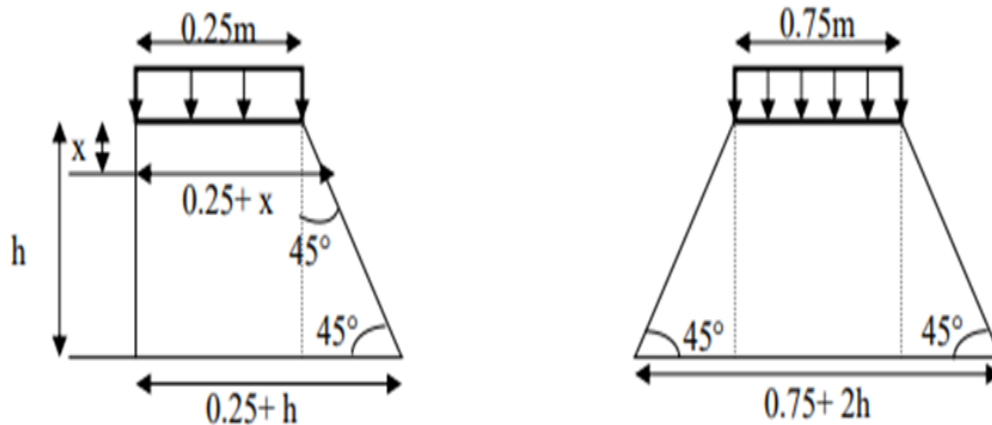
POUSSÉE DE LA CHARGE LOCALE SITUÉE EN ARRIÈRE DU MUR
